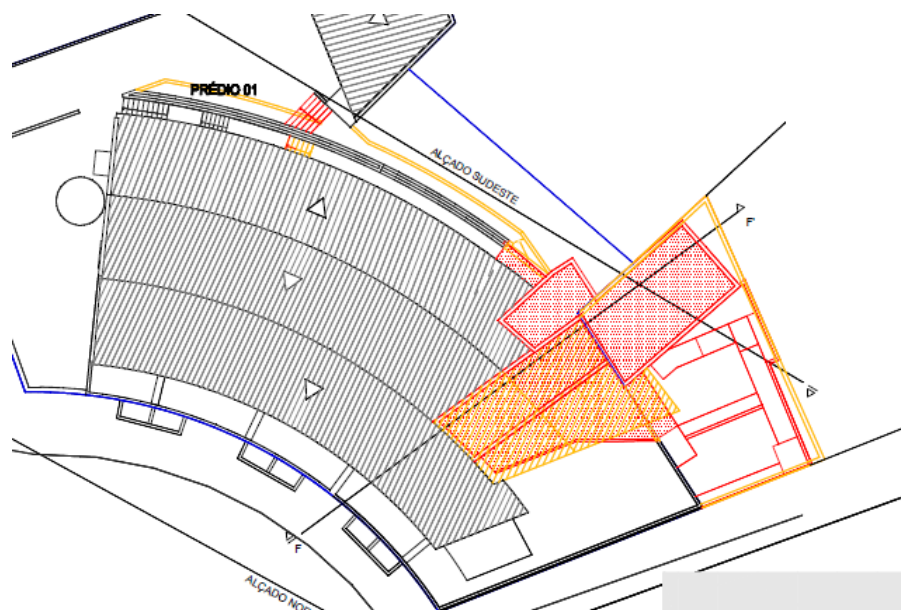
Planta da cobertura - Alterações [Atelier B2, 2016]
